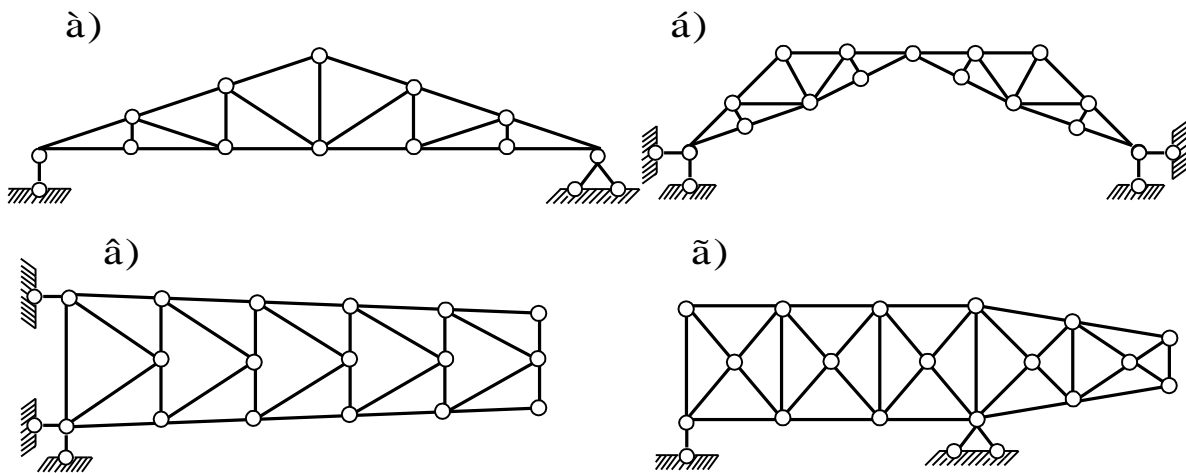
Класифікація ферм за типом обпирання: а – балкова ферма; б – аркова ферма; в – консольна ферма; г – консольно-балкова ферма
